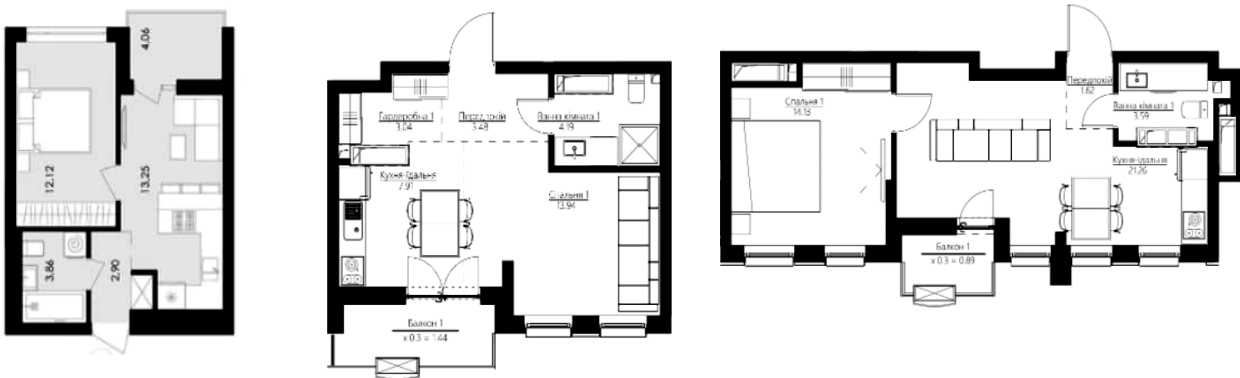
Зразки планувальних рішень компактних квартир у новобудовах
